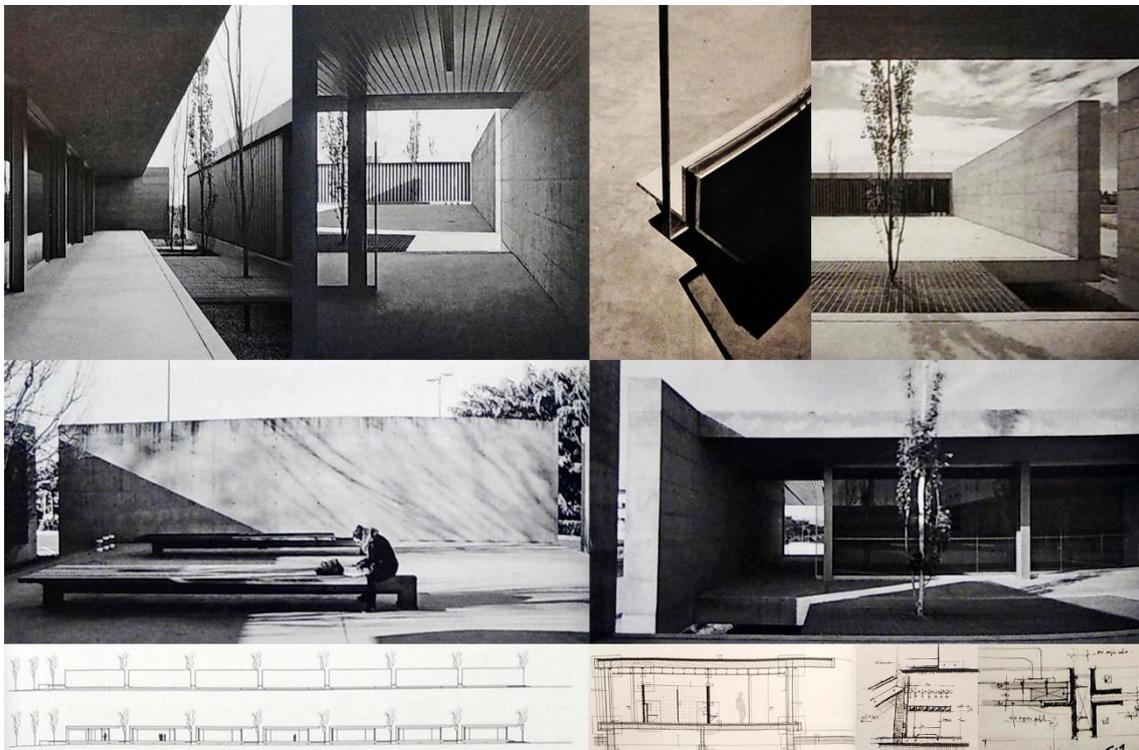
Vistas exteriores, detalle carpintería, alzado y sección, sección constructiva y dibujos.
